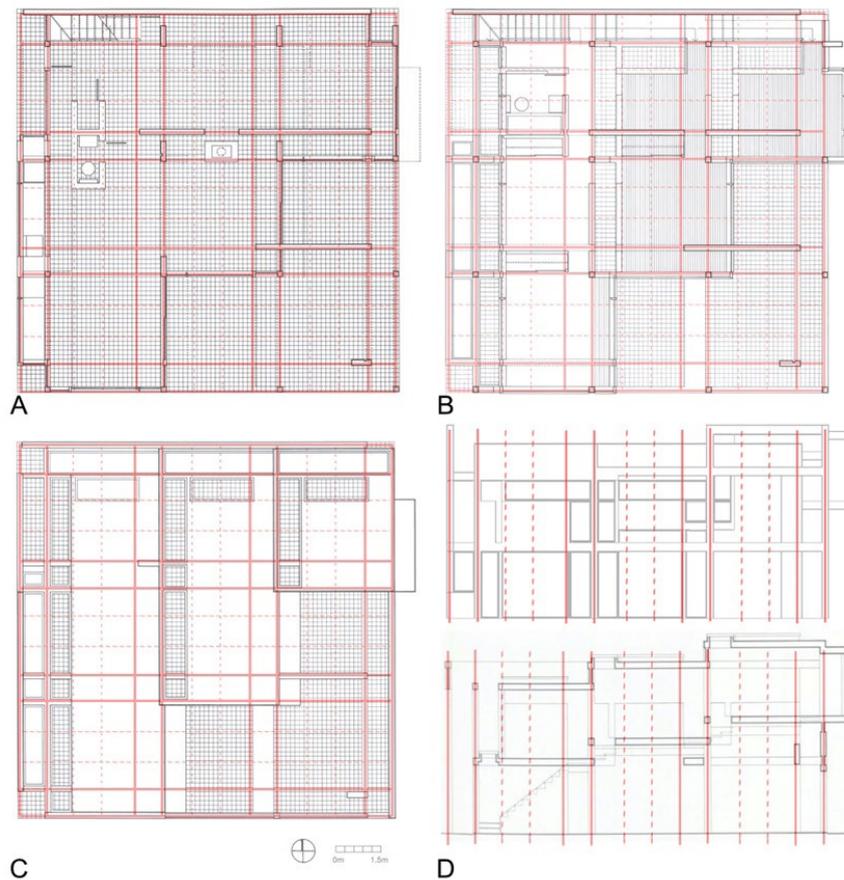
(A, B e C) Plantas-baixas da *House II* com o *grid* secundário inserido. (D) Fachada e corte com o *grid* secundário inserido.
